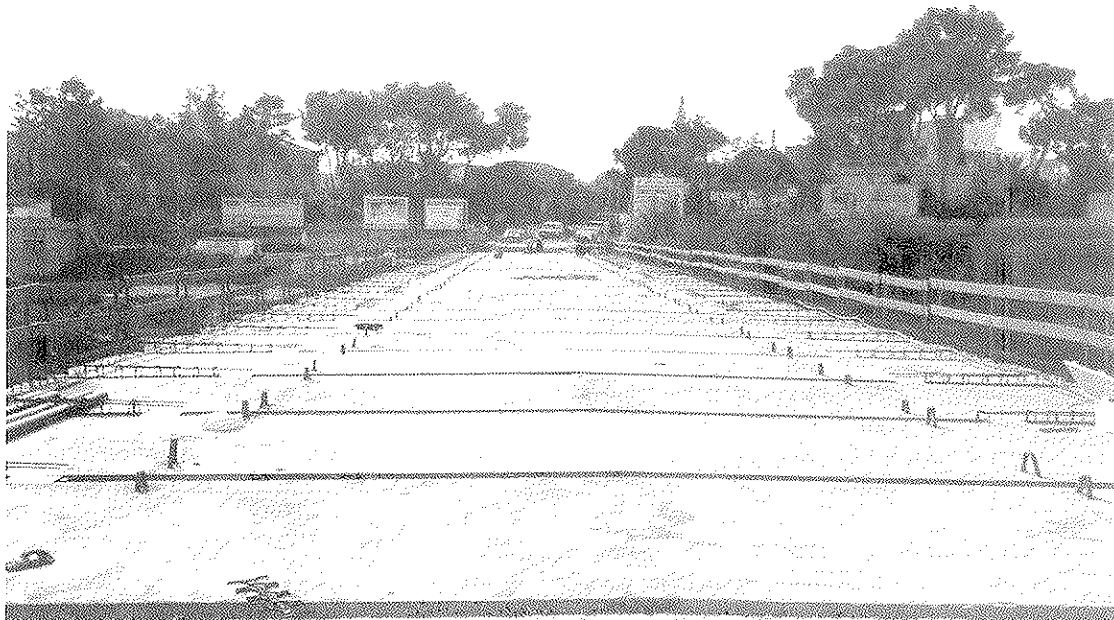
Disposición de las losas de hormigón ligero empleadas en la ampliación del puente sobre el barranco del Torrent [7].
